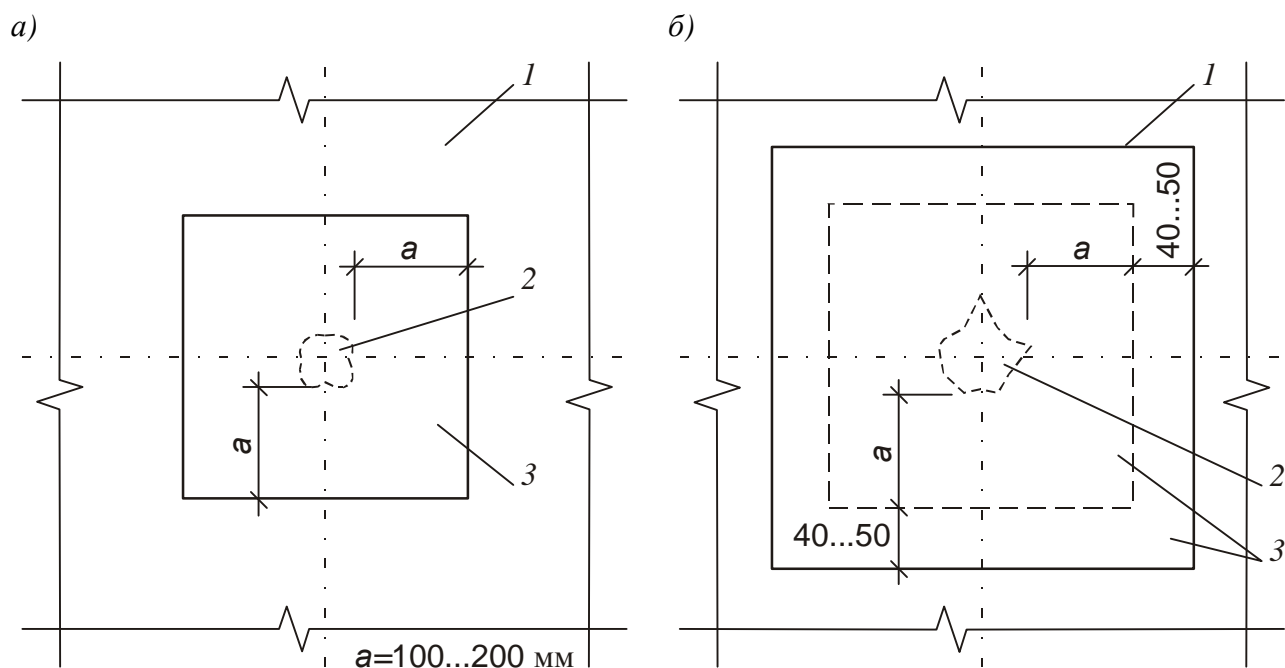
Заплаточный ремонт стальных кровельных покрытий при повреждениях: a – до 50 мм; b – 50...200 мм; 1 – кровельное покрытие; 2 – повреждение; 3 – заплата
